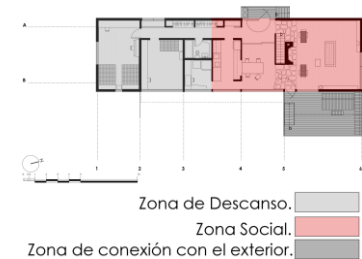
Disposición de las zonas de vivienda en planta alta. Fuente: Autor
